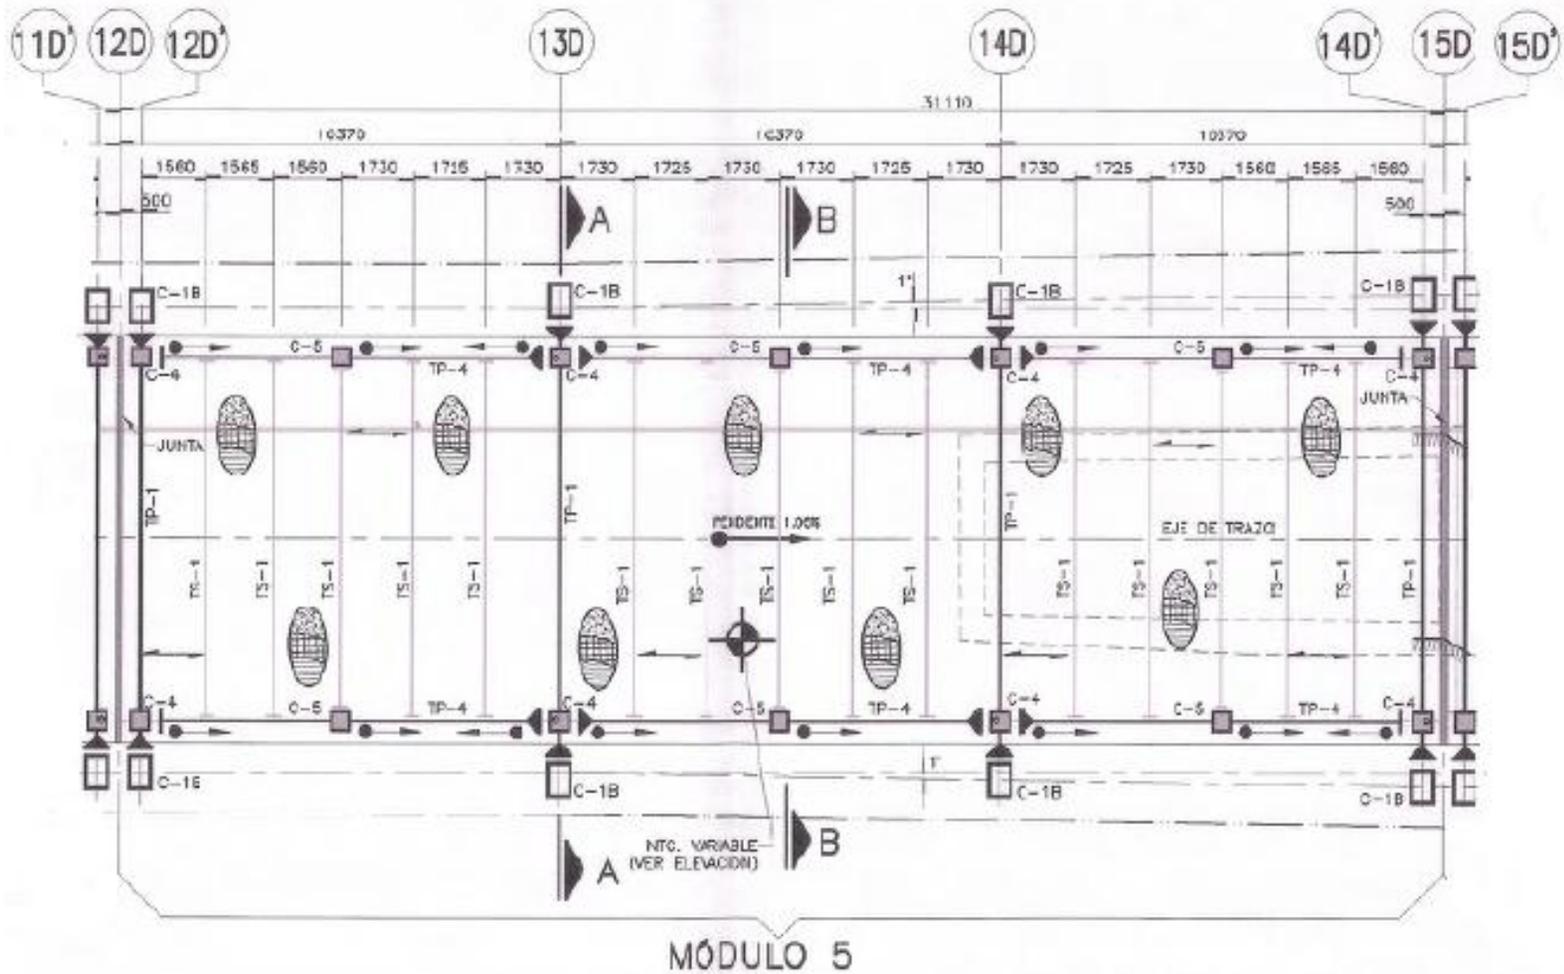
Planta de estructuración nivel pasarela, módulo 5.
